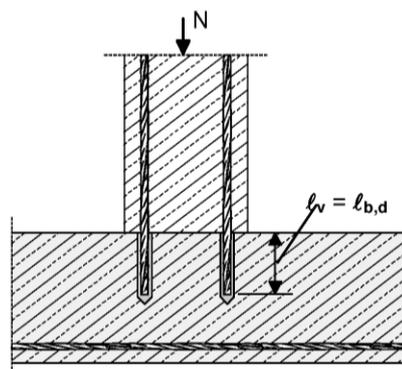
Bewehrungsanschlüsse überwiegend auf Druck beanspruchter Bauteile
